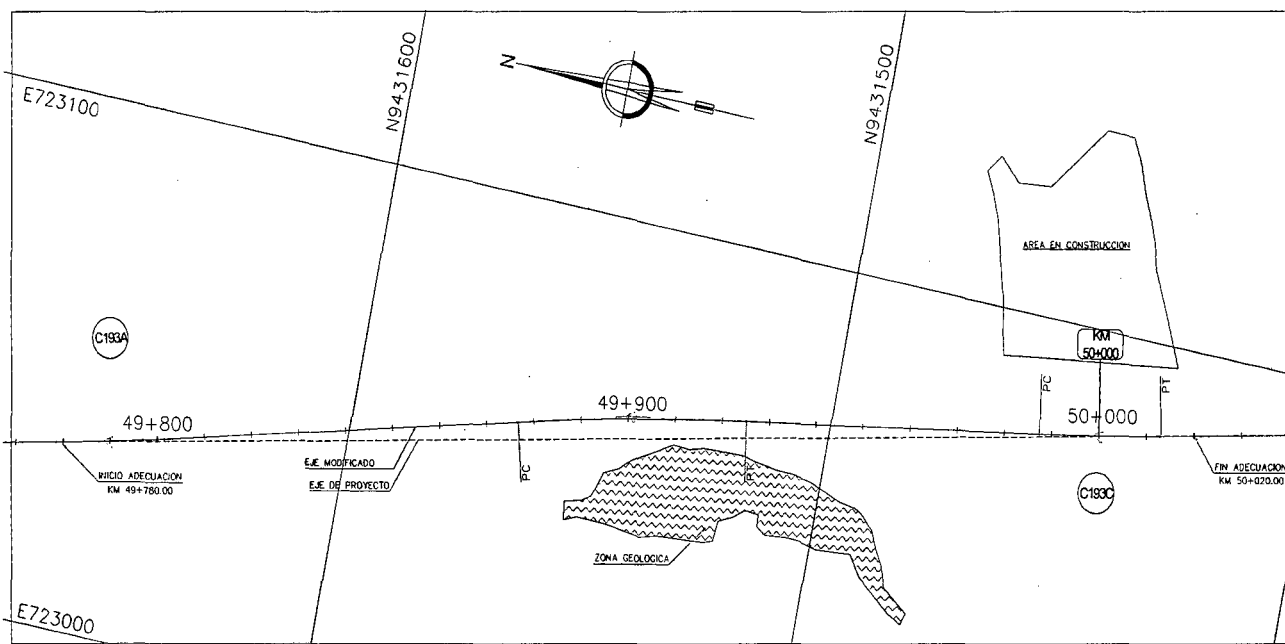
Plano en planta de la comparación del eje del proyecto y el replanteo de la variante 03.
